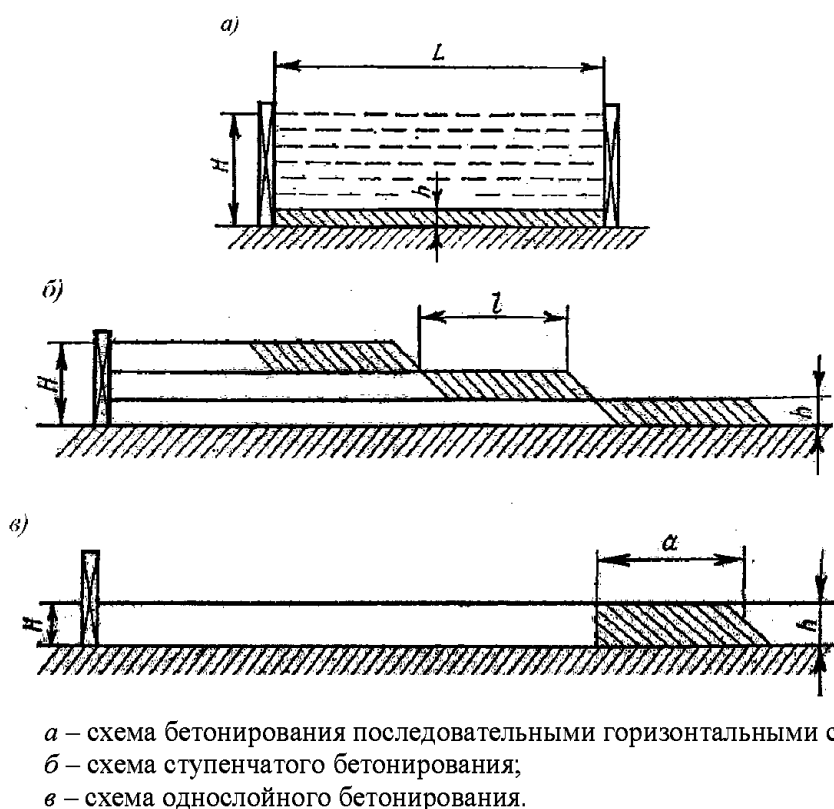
Основные схемы укладки бетонной смеси в блоки
